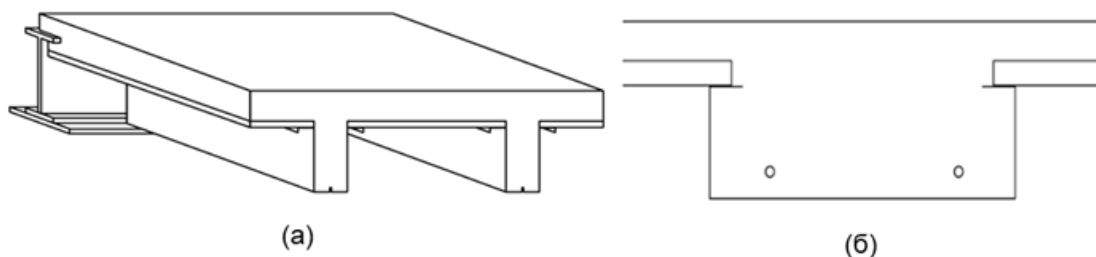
Образование ребер монолитных перекрытий сборным настилом:
